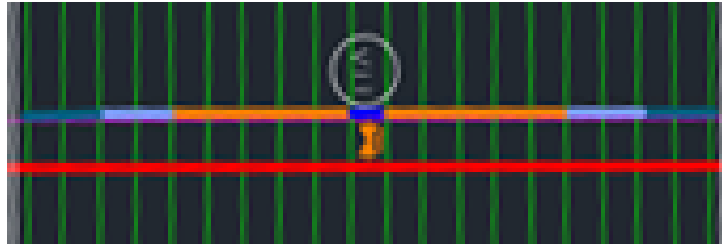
Distribución de la tubería en el plano. Fuente: propia
